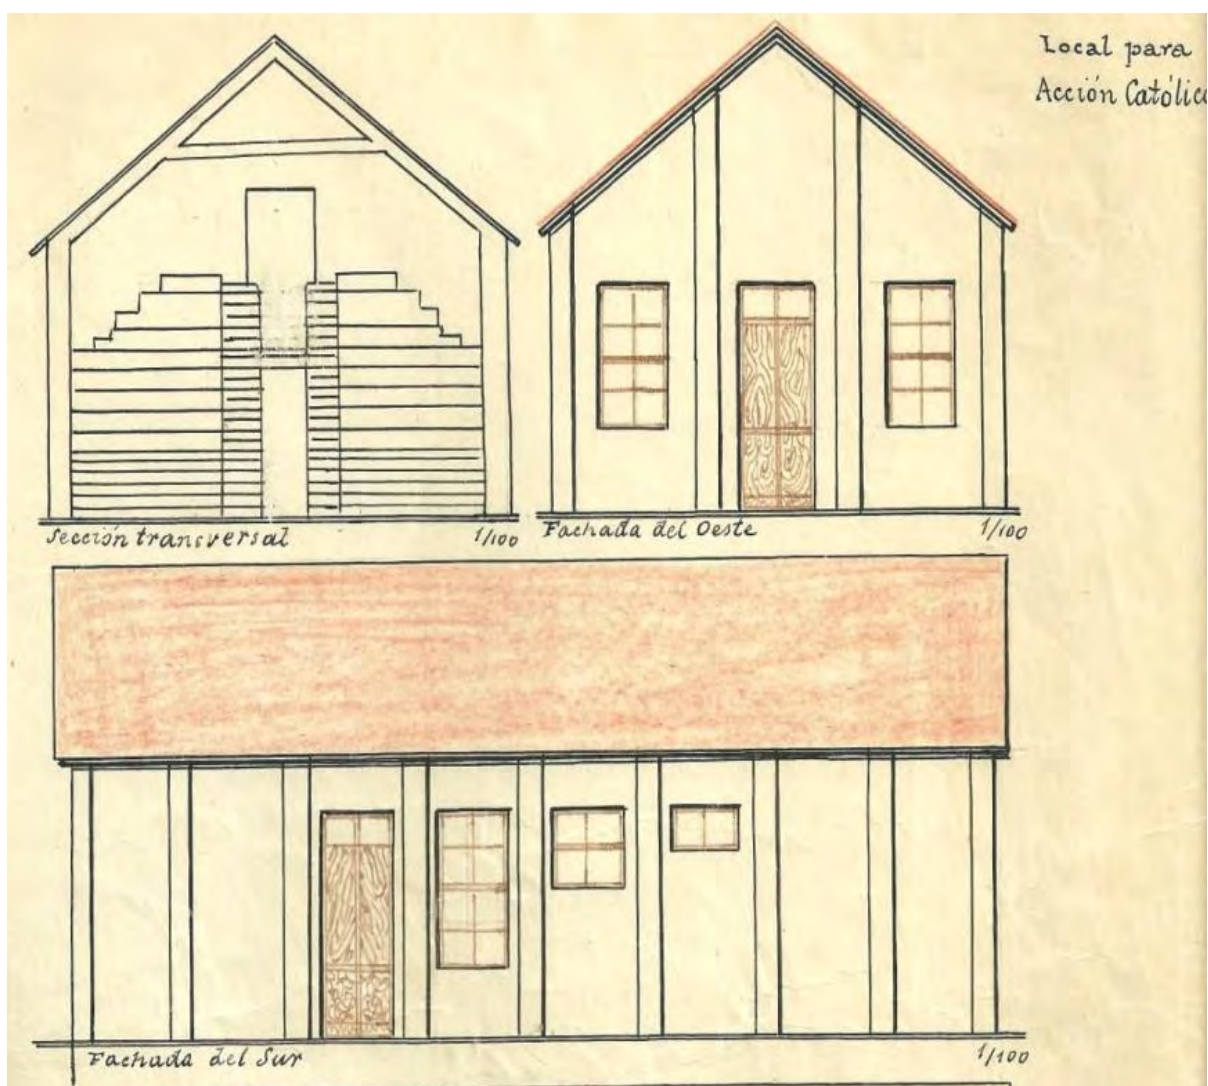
Planos dibujados por D. Ramón (1929) de la fachada Oeste y Sur y sección transversal del interior
